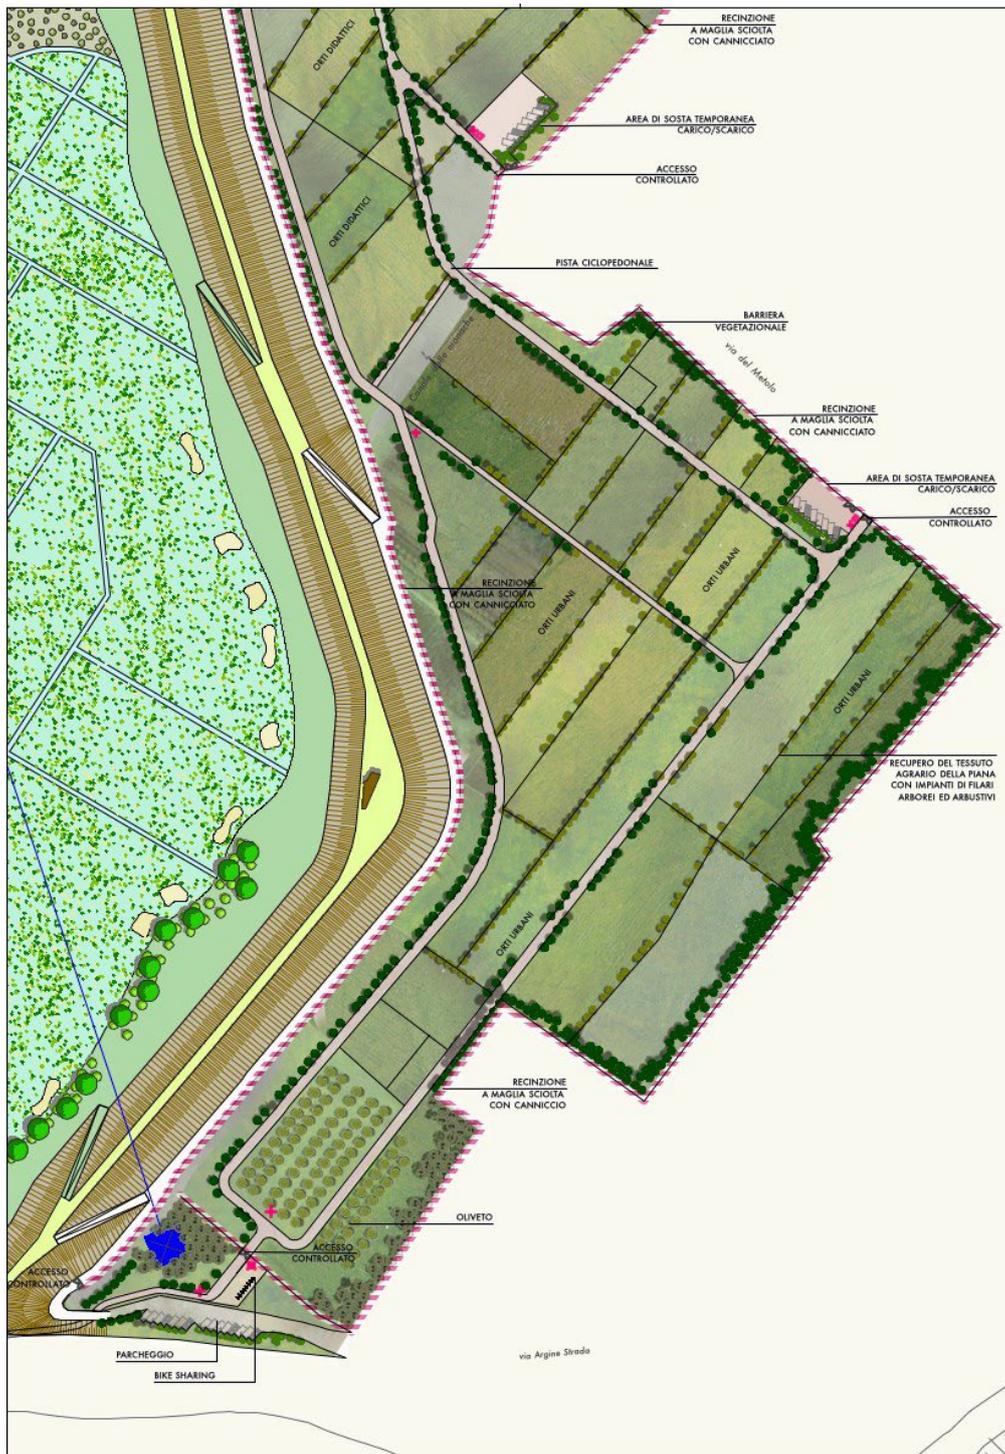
Planimetria del progetto degli Orti Urbani
